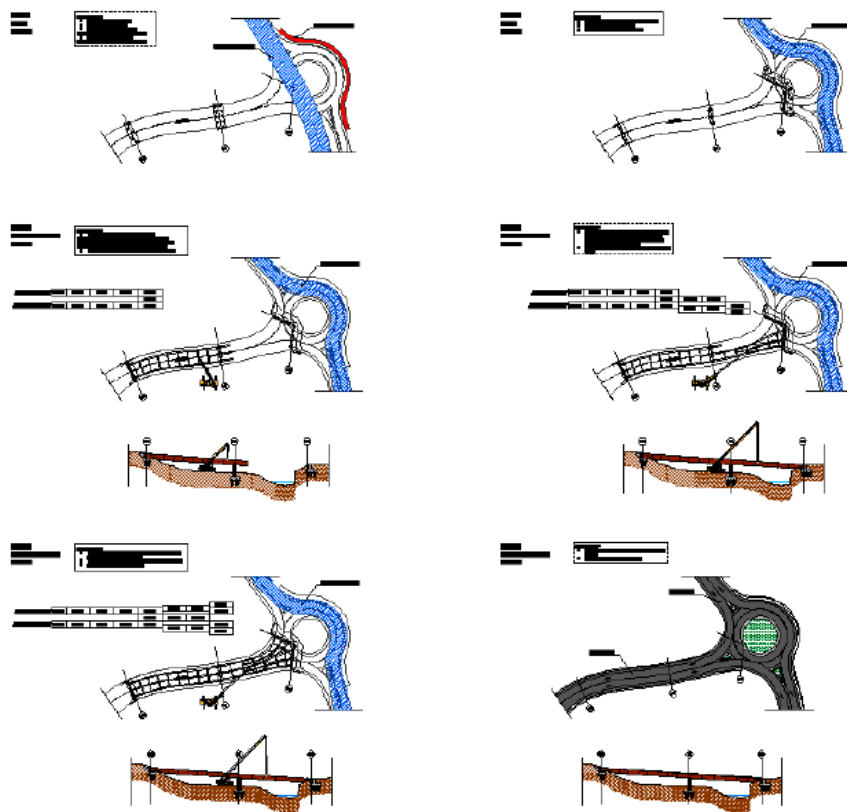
Cantiere Varo viadotto sul fiume Ermena
